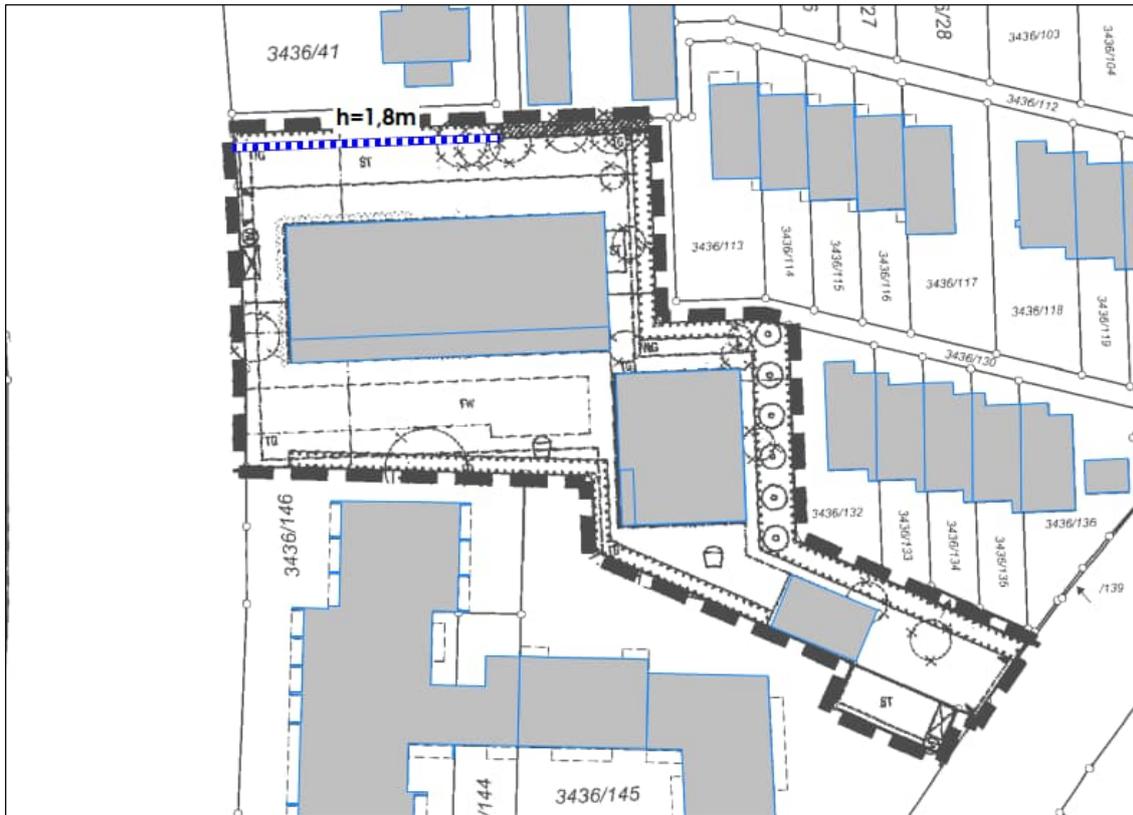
Lageplan mit Darstellung der zu errichtenden Lärmschutzwand
